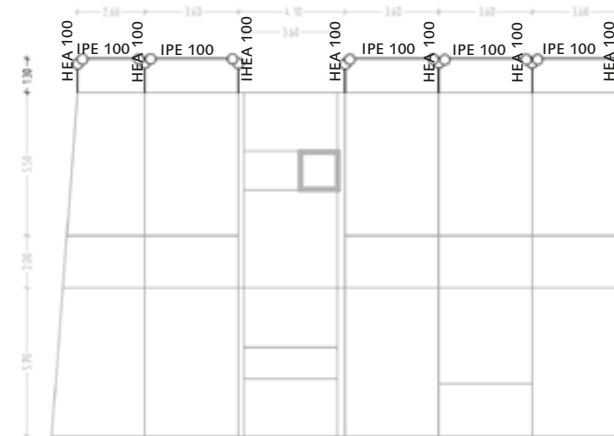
Balkonsystem im Grundriss [m]
